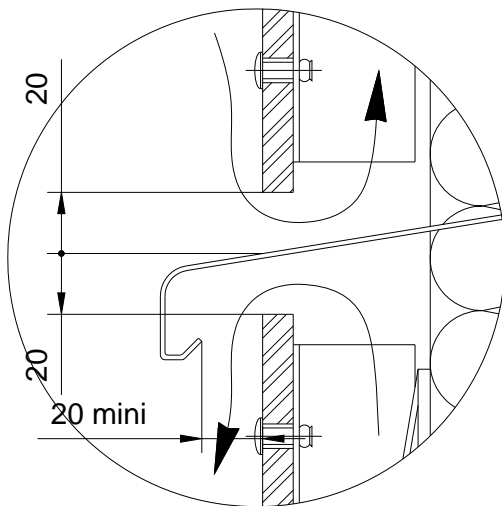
Coupe horizontale sur tableau de baie avec isolation extérieure à joint ouvert
